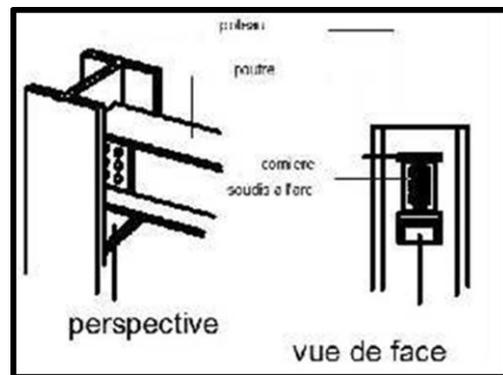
Assemblage boulonné d'une poutre à l'âme d'un poteau
